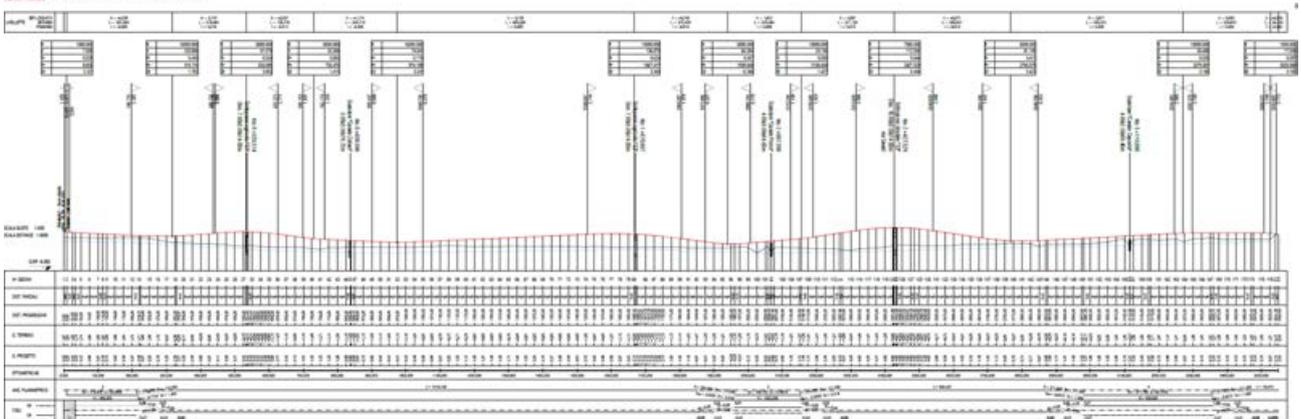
PROFILO DELL'INFRASTRUTTURA DI PROGETTO
